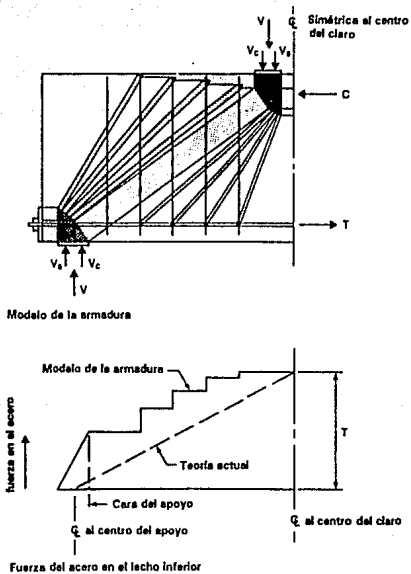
Modelo de la armadura plástica para una viga con estribos (Ref. 3)
